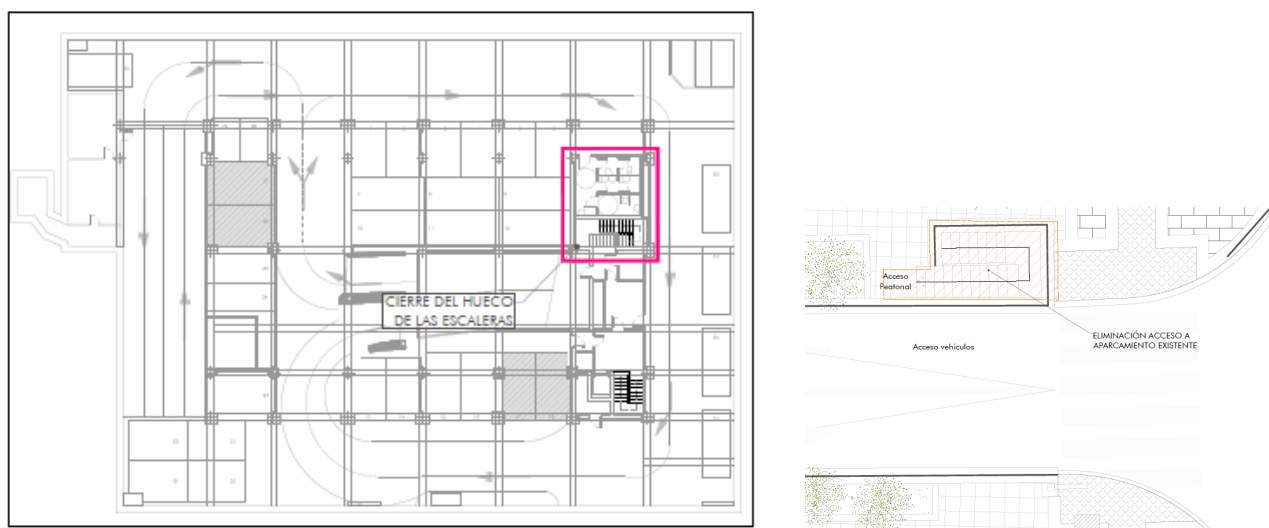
Actuación cierre núcleo de escaleras– Vista en planta
